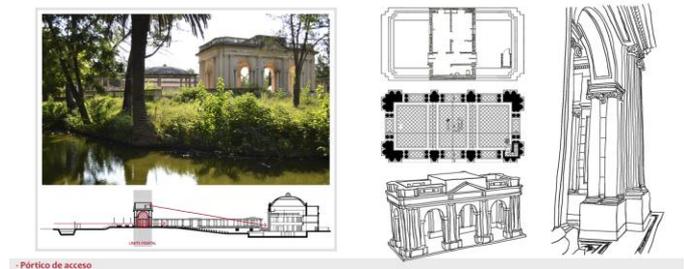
El pórtico de Acceso. Fuente: Elaboración propia.
